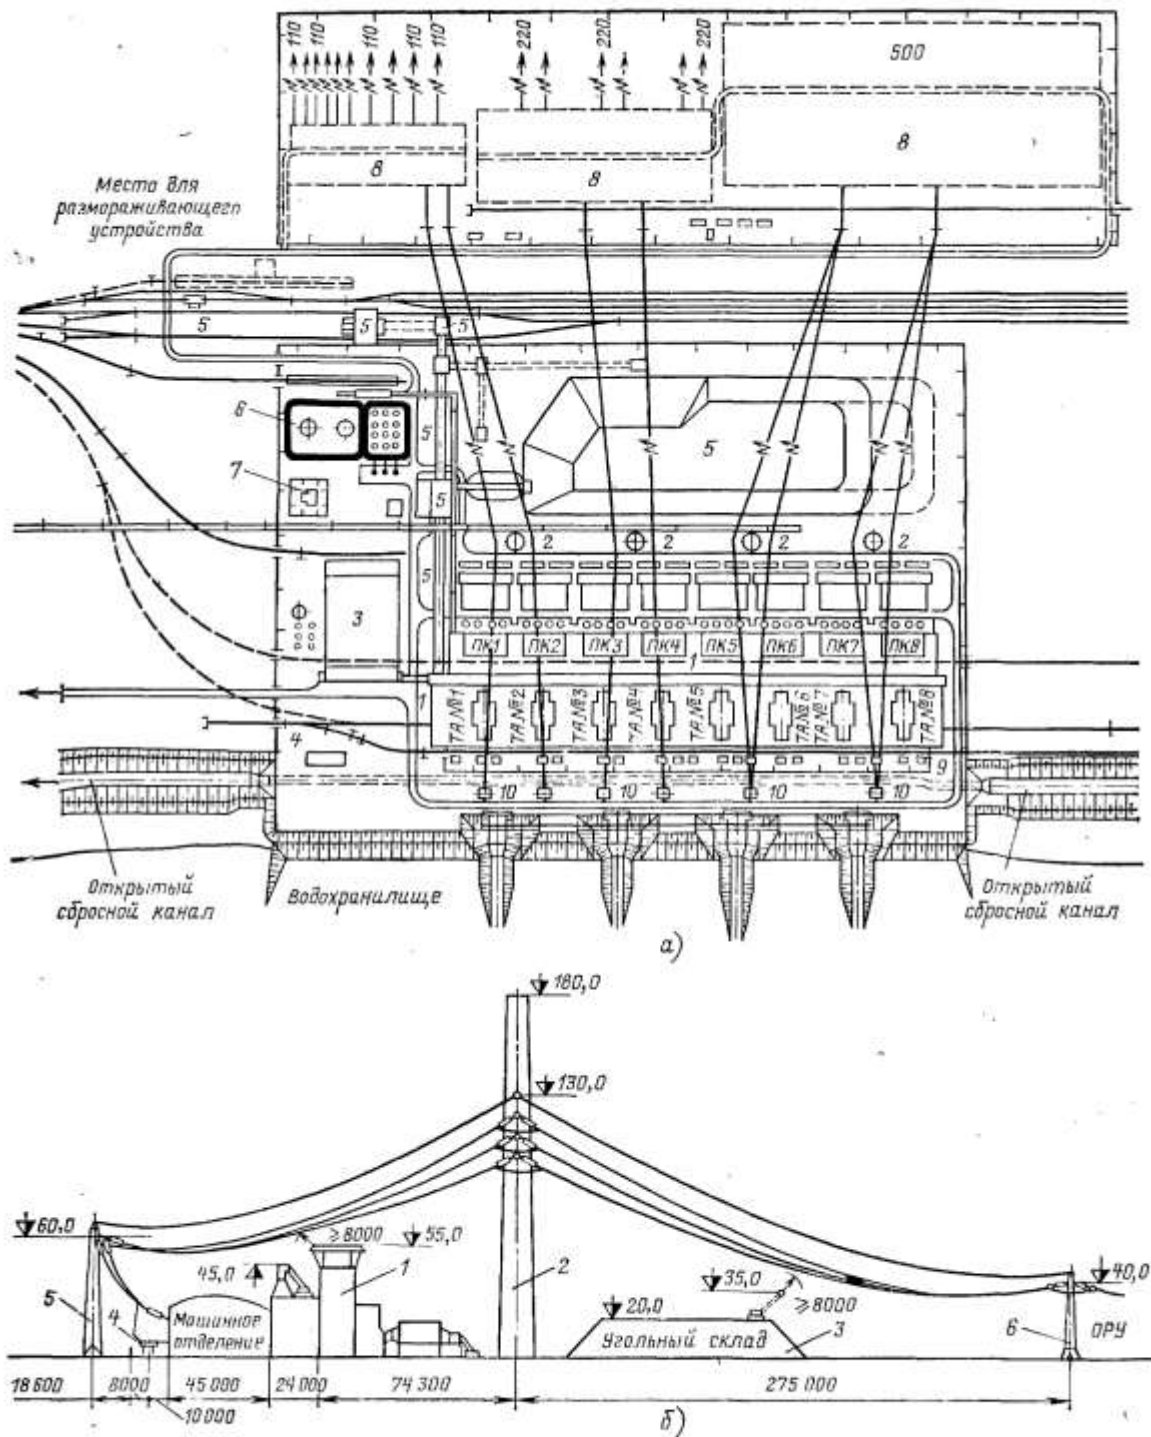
Генплан пылесугольной электростанции 2400 МВт с размещением ОРУ за угольным складом:
